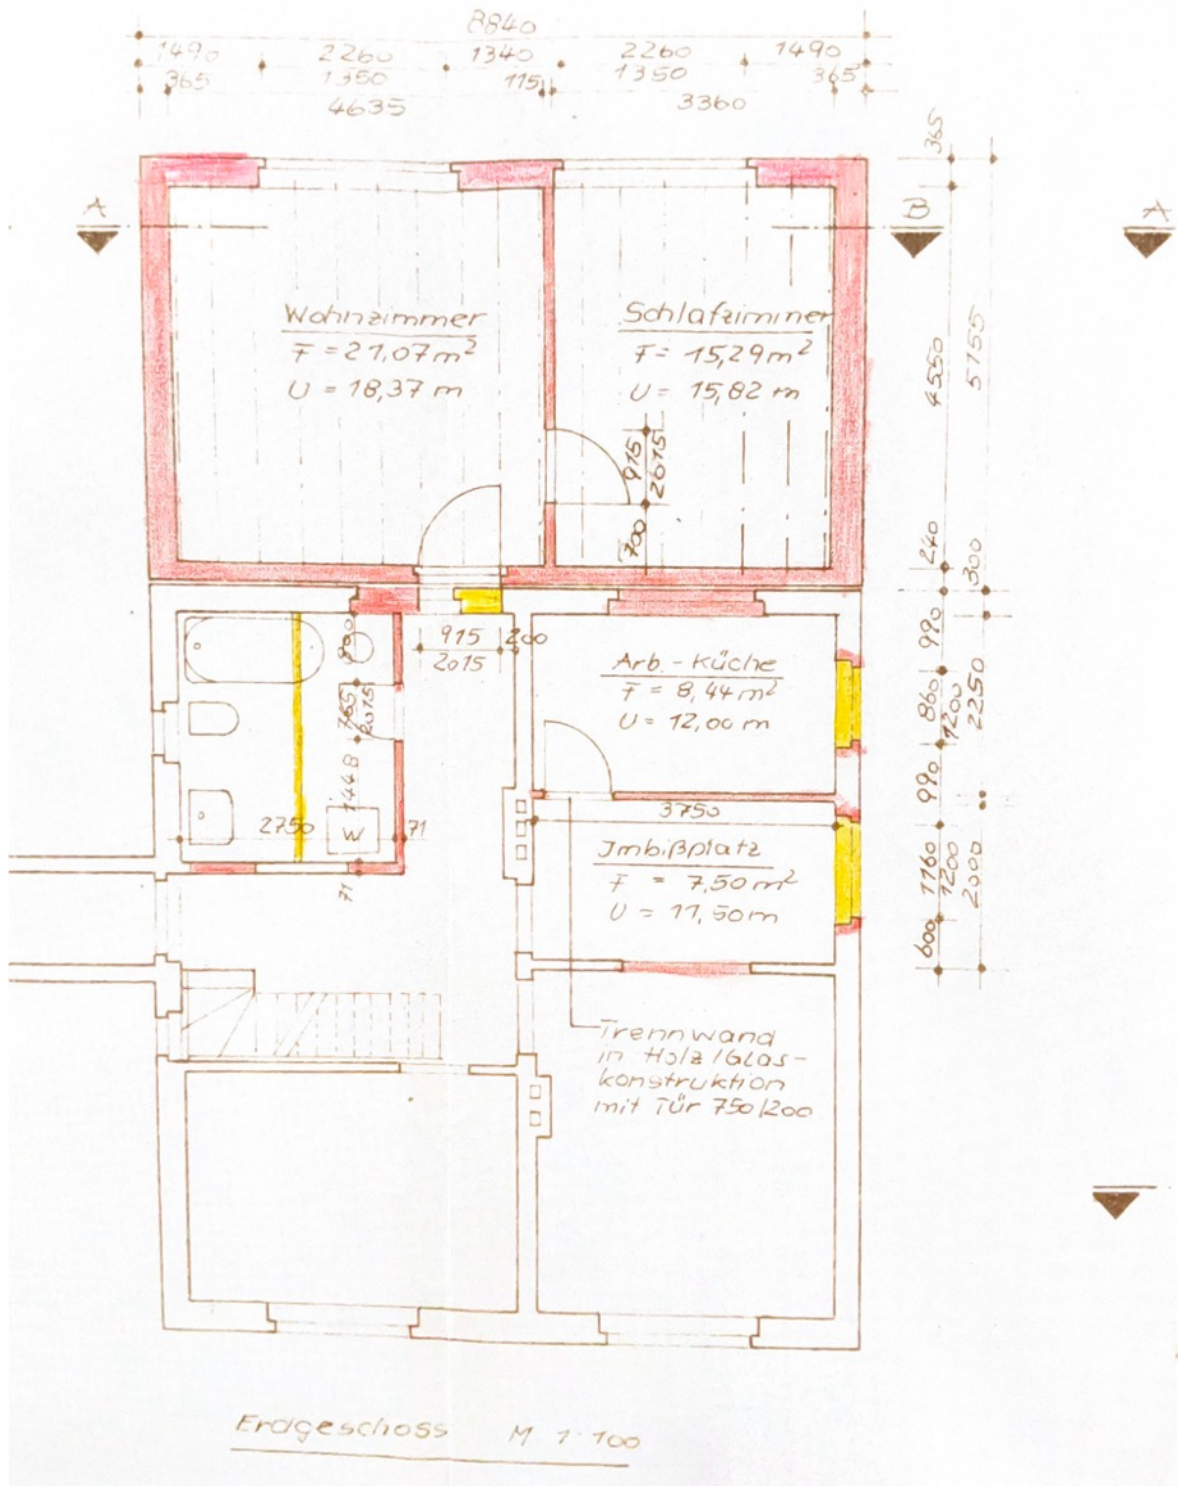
Grundriss Erdgeschoss von 1975
